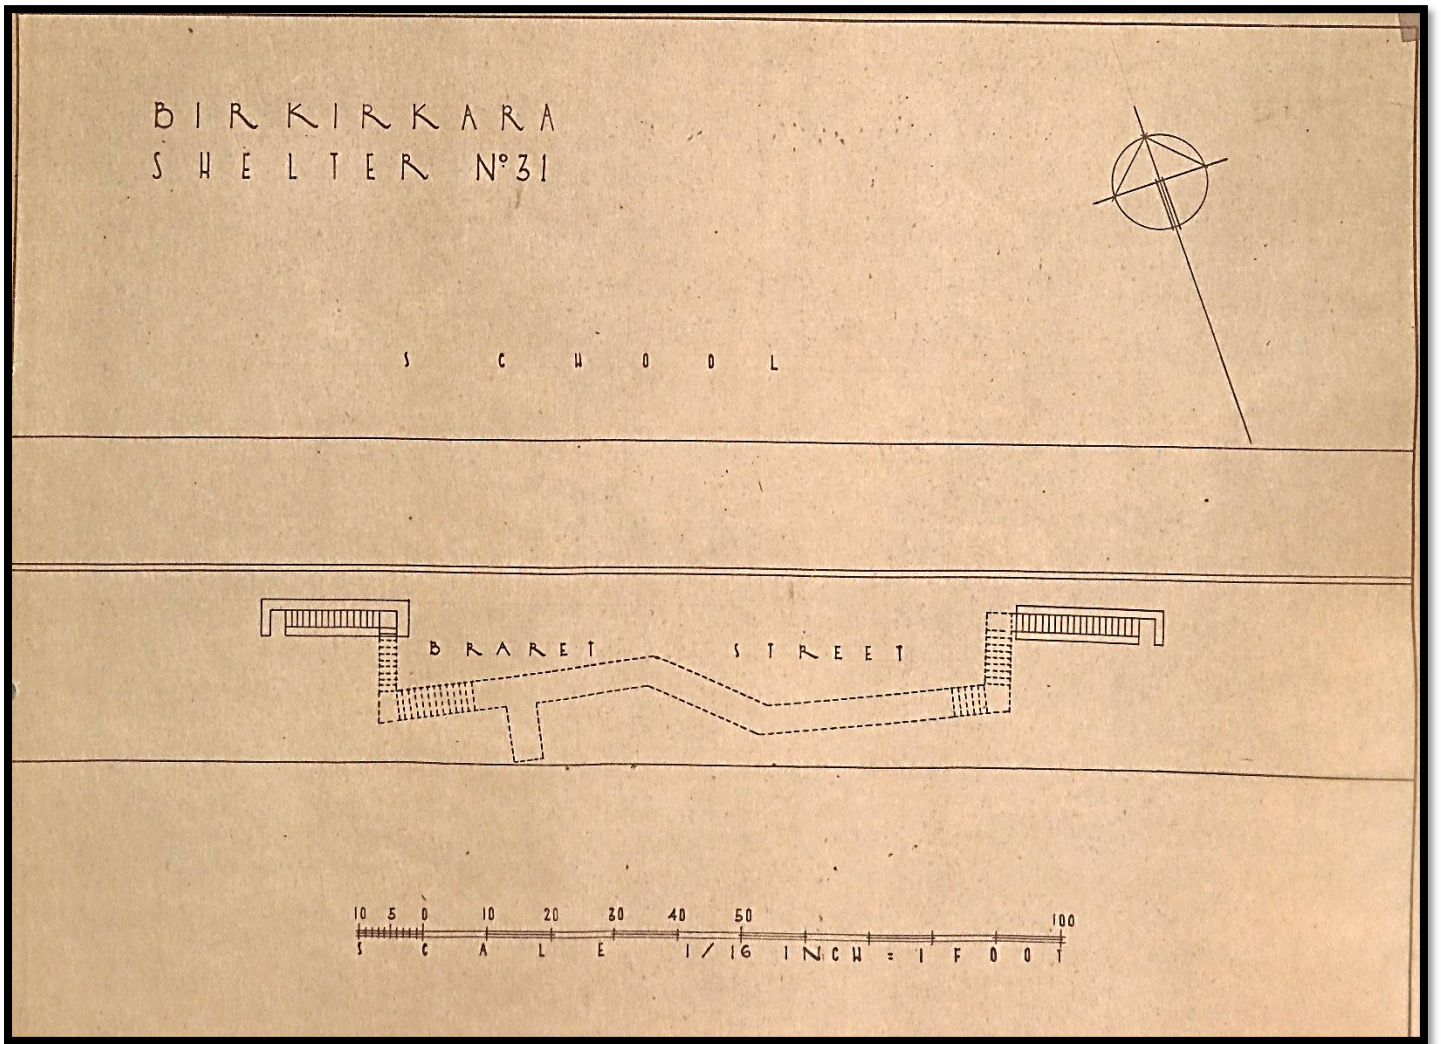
Planta do Abrigo nº 31 "Braret Street"
